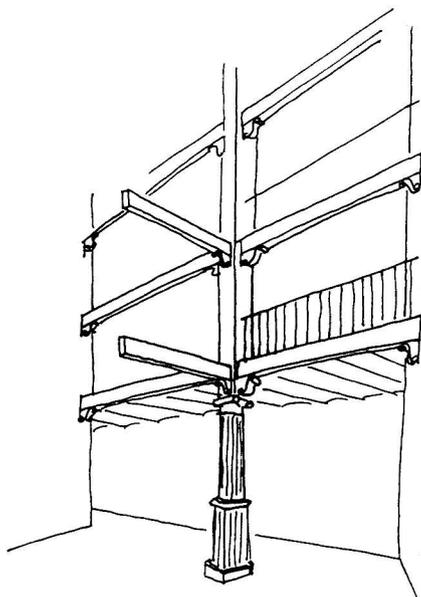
San Blas 12. Estructura de la parte central de la casa.
